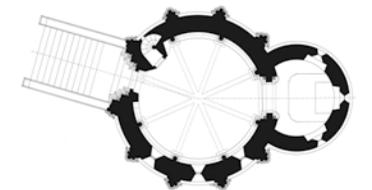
Grundriss Hairtsch/Blasch 1989. M 1:400.
